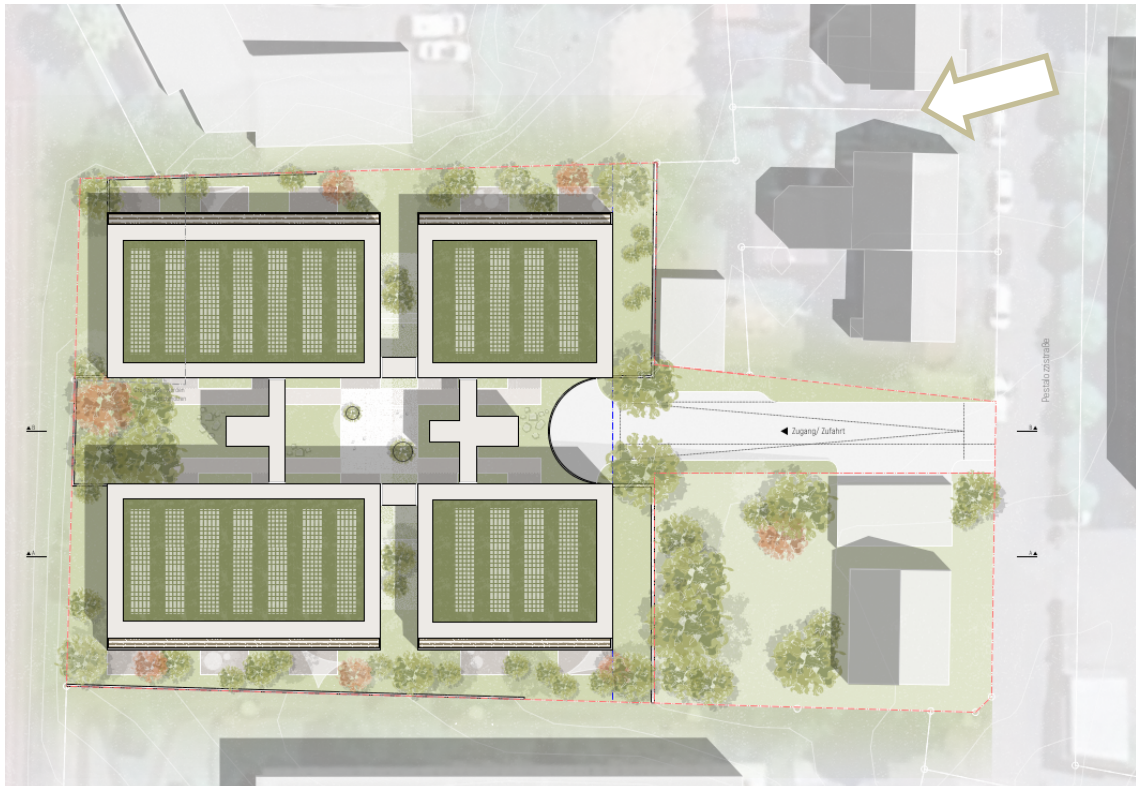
Bauvorhaben Pestalozzistraße, Architekturbüro Müller+Partner, Oberkirch, Oktober 2025
